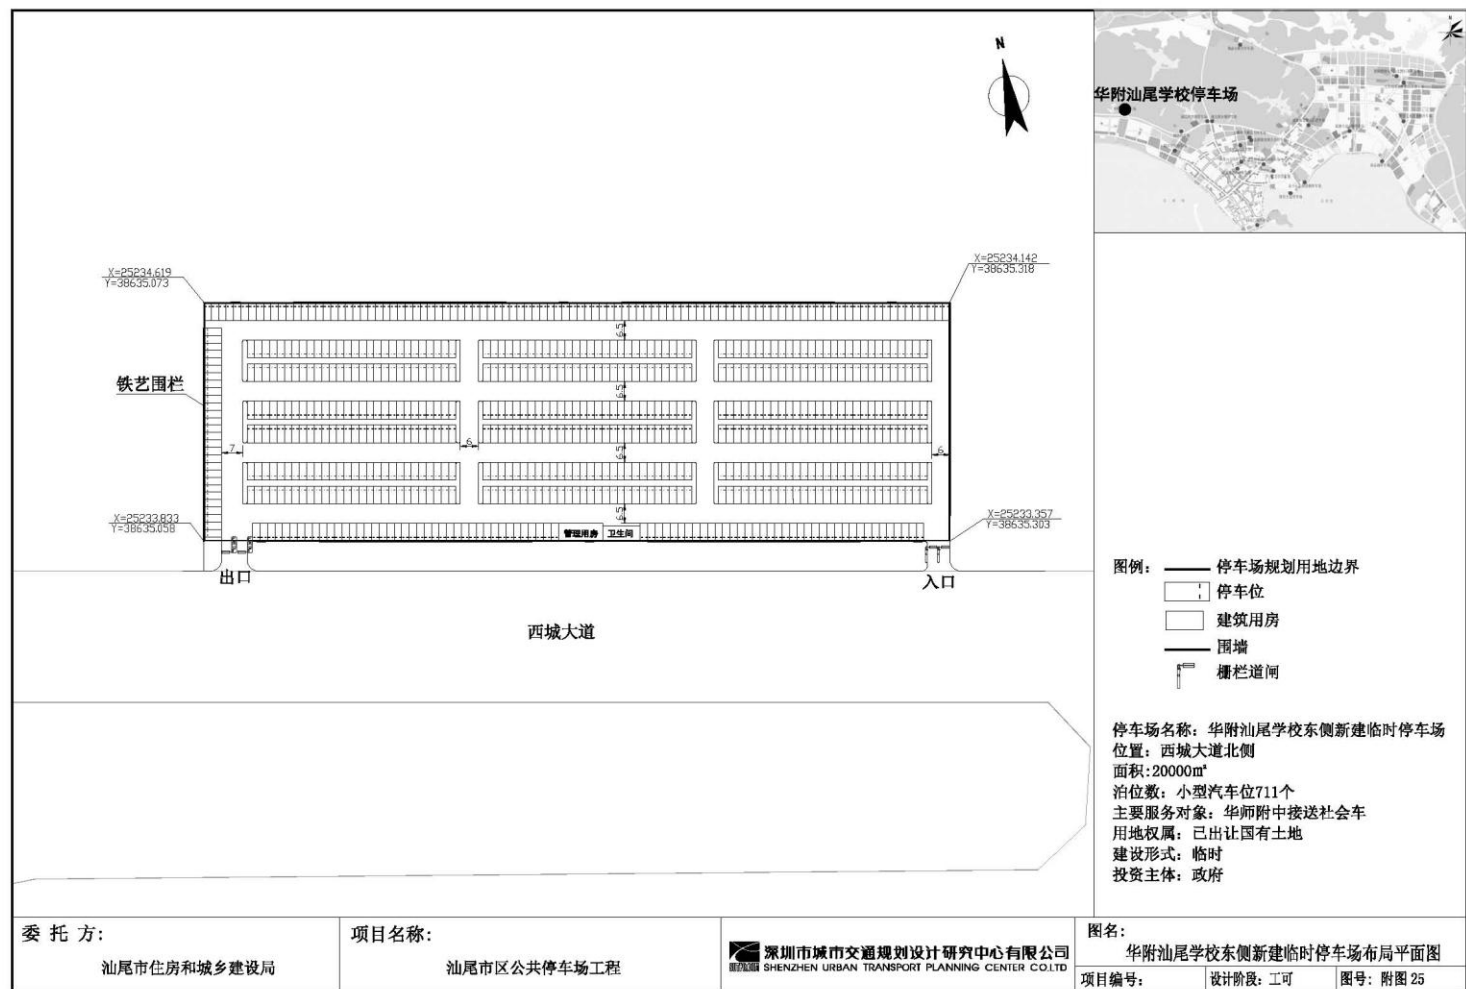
华附汕尾学校东侧新建临时停车场布局平面图
